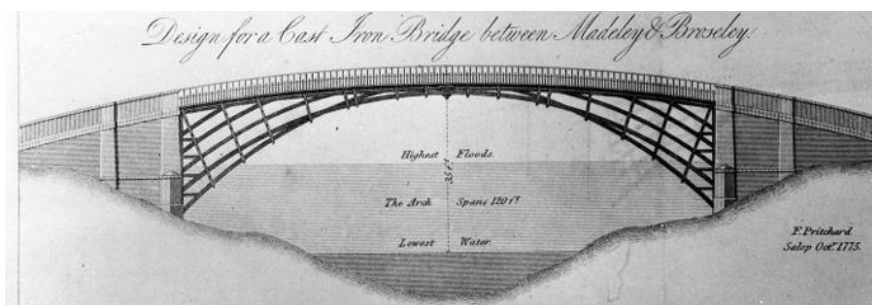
Última Versão do Projeto da Ponte e Posteriormente Revista, 1775 (Museums, n.d.).
